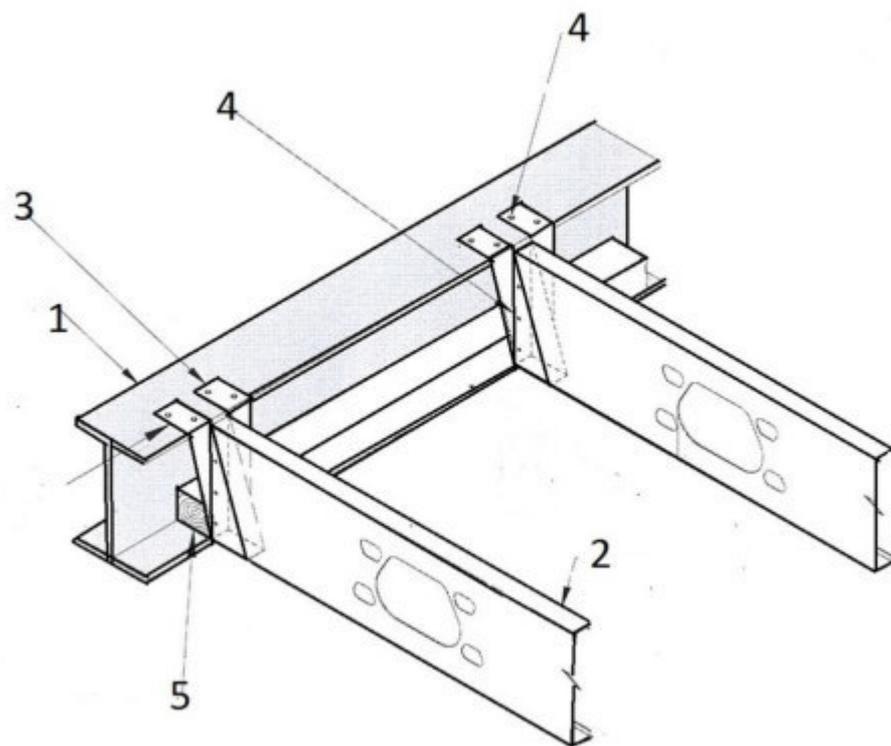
Перекрытие по прогонам из балочных ферм
